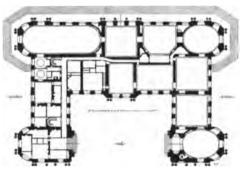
Palais Bourbon zu Paris. Grundriss des Erdgeschosses.
